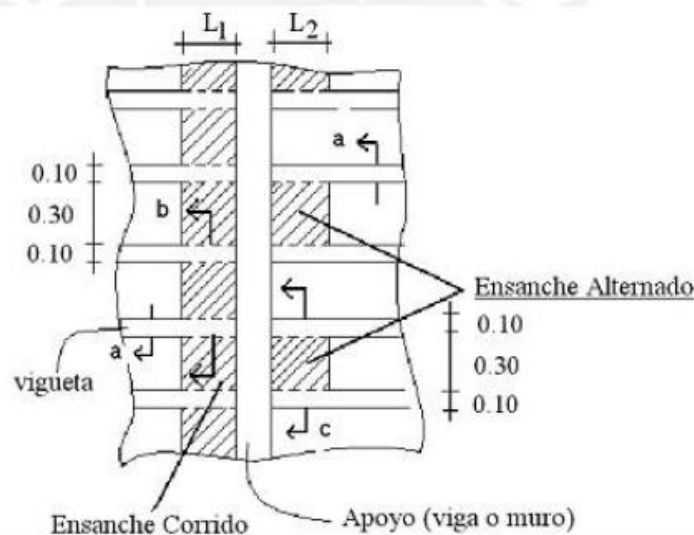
Vista en planta de los ensanches alternados y corridos.
